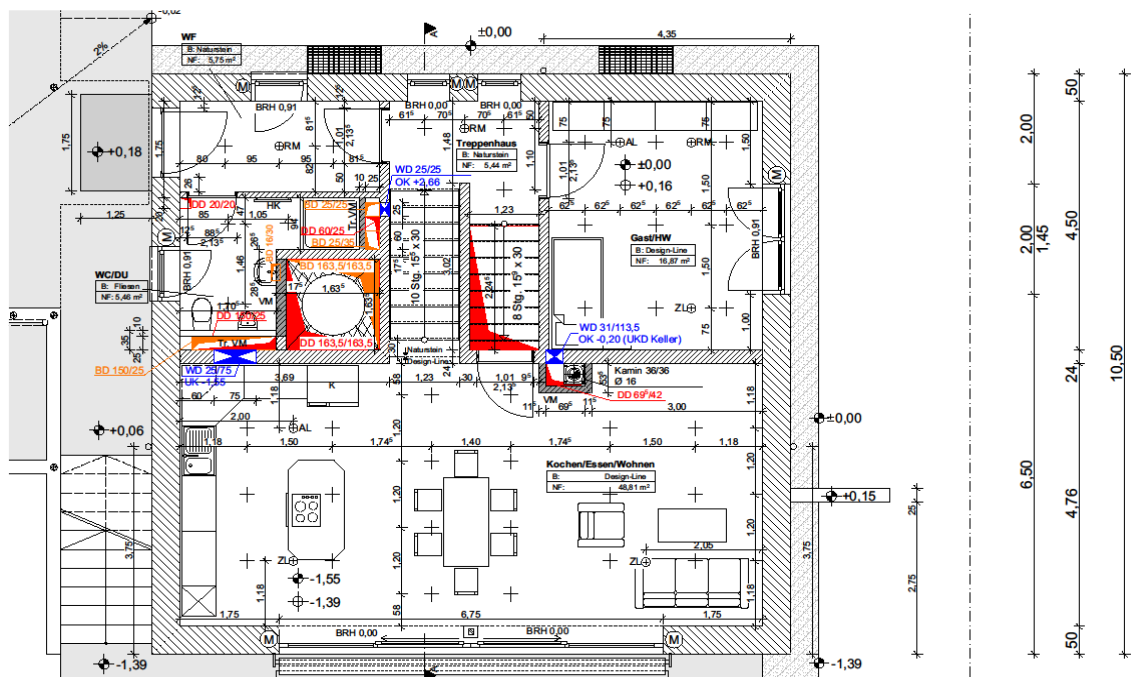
Grundriss (EG) des Gebäudes 1 (Schröder, 2015)
